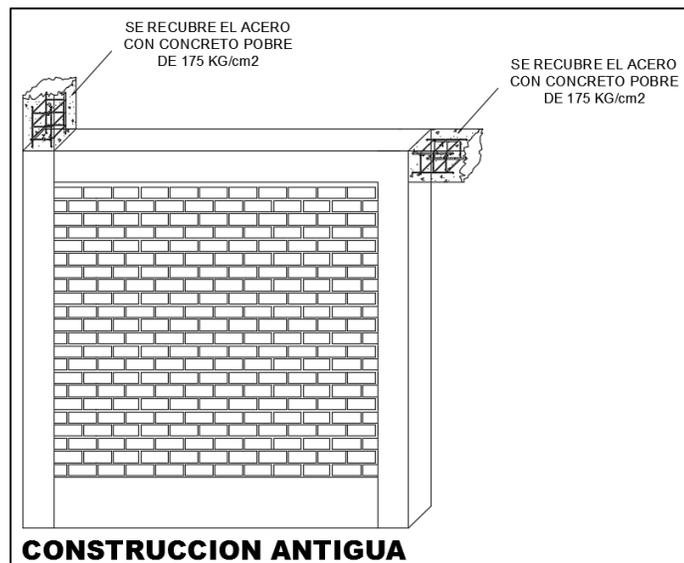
Construcción antigua con recubrimiento en vigas y columnas.
